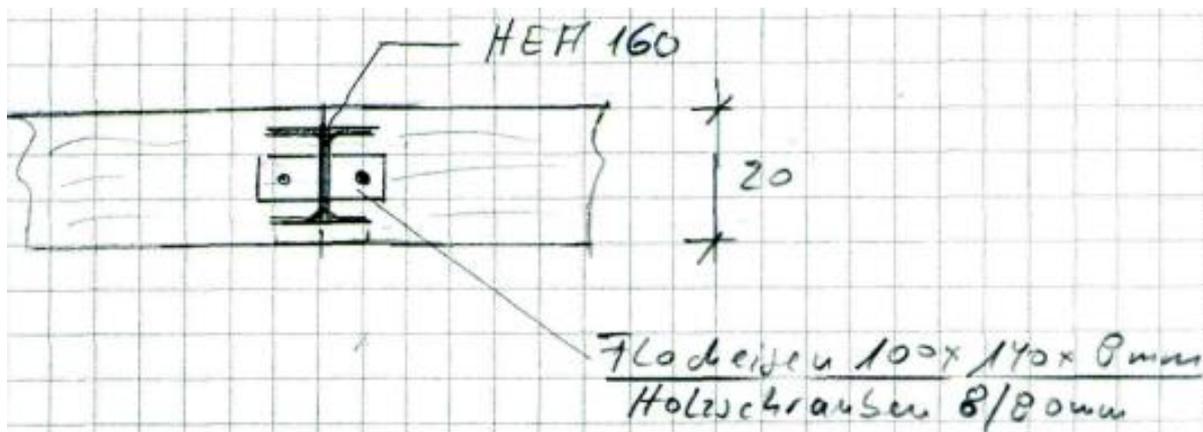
Anschluss Dachsparren an Unterzug HEA 160, Cramer Engineering
